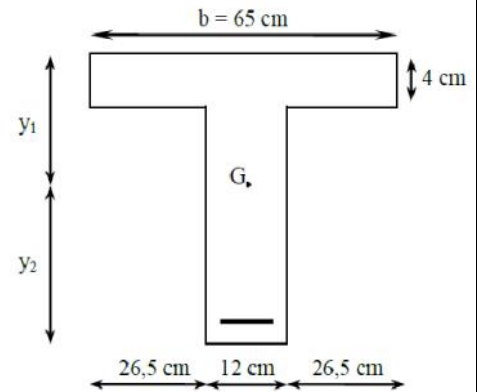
Plan de ferrailage de plancher en corps creux.
